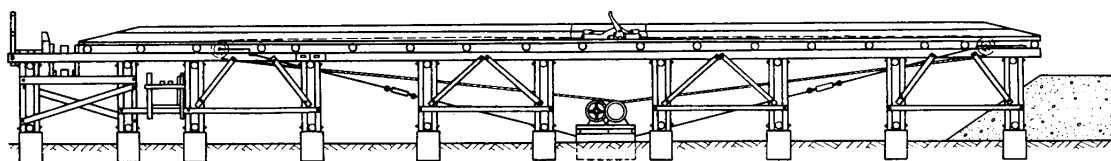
Схема установки ЛТ-10 на железобетонных сваях
